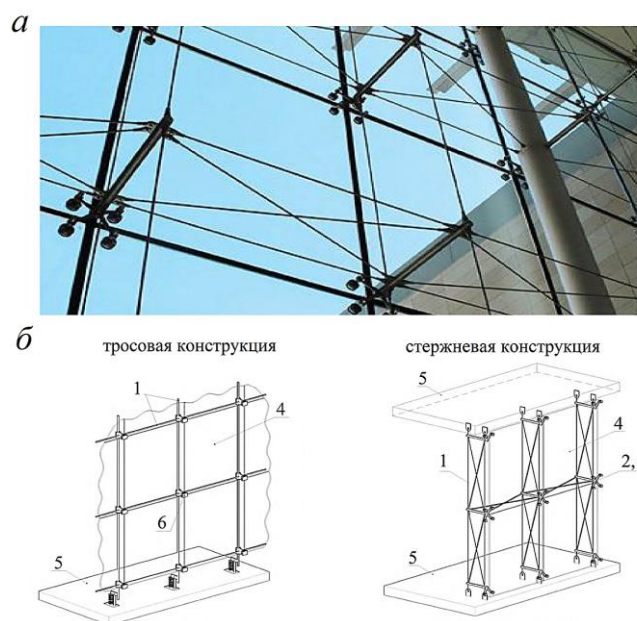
Вантовая фасадная система: а – общий вид фасада; б – конструктивные схемы;
